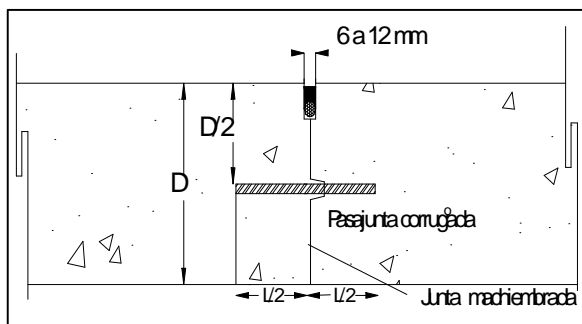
Junta longitudinal de construcción con pasajunta corrugada y machimbre.
